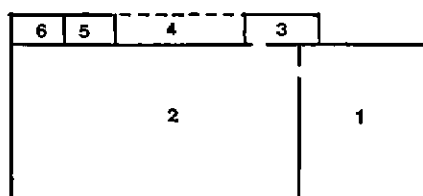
Plan de l'unité de stockage. (Plan of Storage Unit — Plano de la unidad de almacenamiento.)
